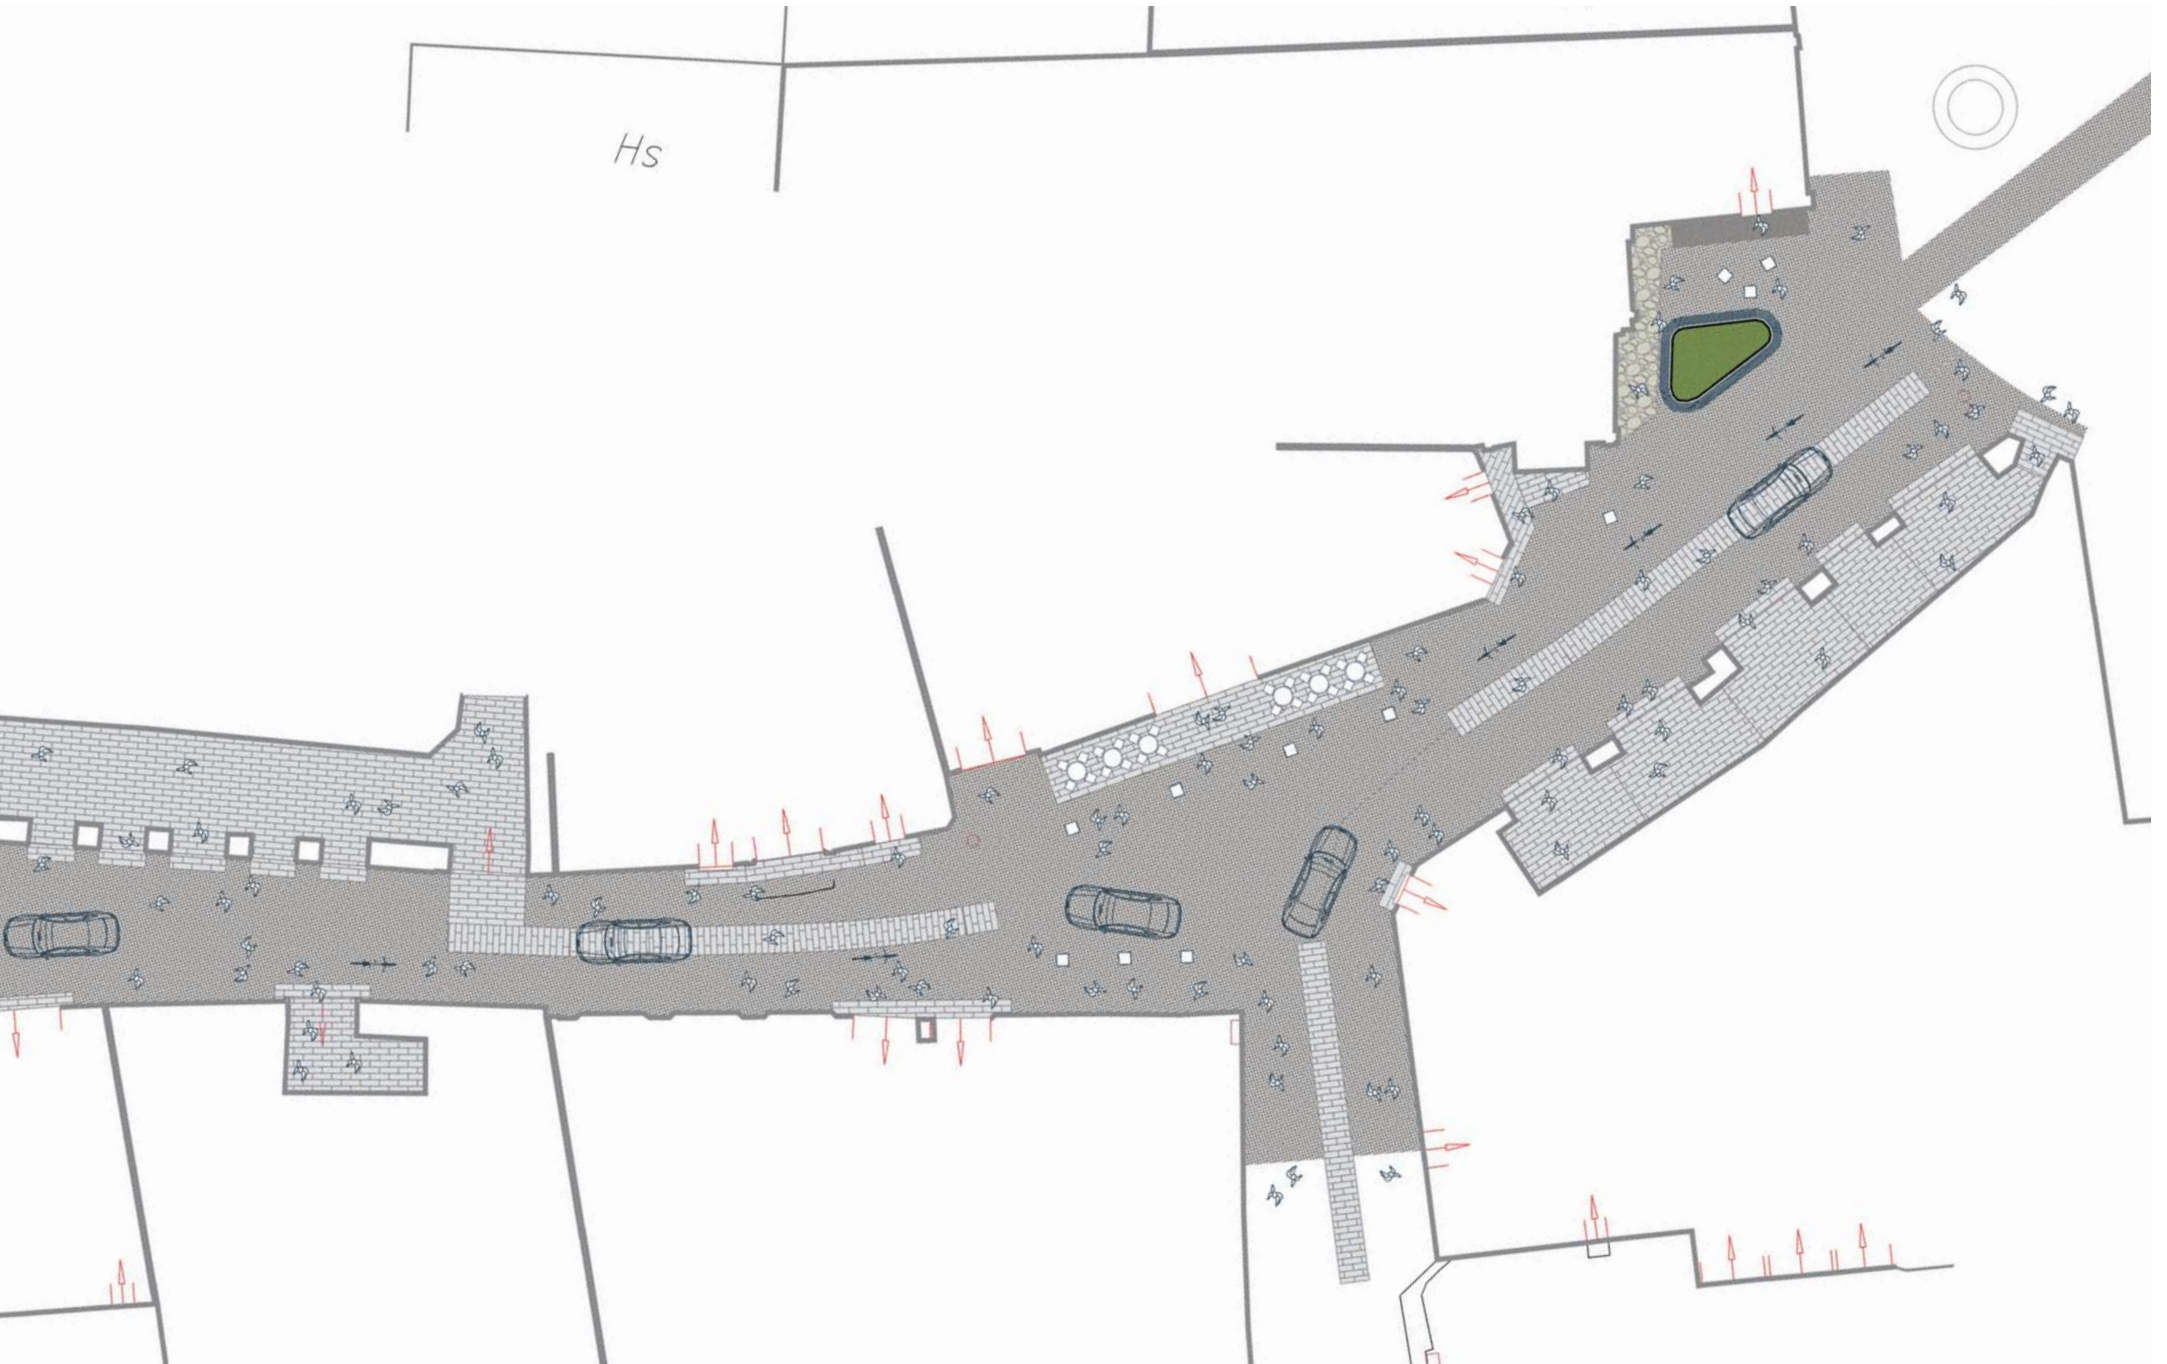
Entwurfsgrundriss mit Oberflächengestaltung
